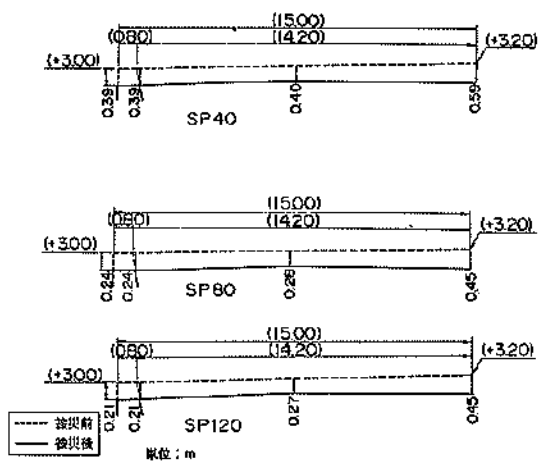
(b) 北埠頭北側岸壁縦断面図 (函館港)
